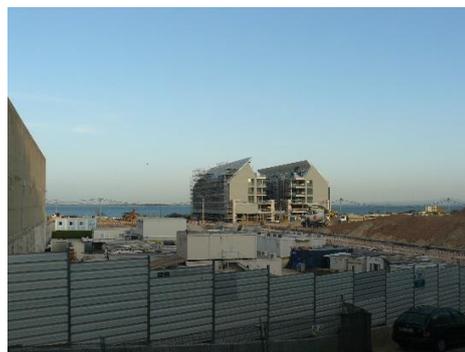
Vista da construção mais avançada das primeiras unidades habitacionais.
